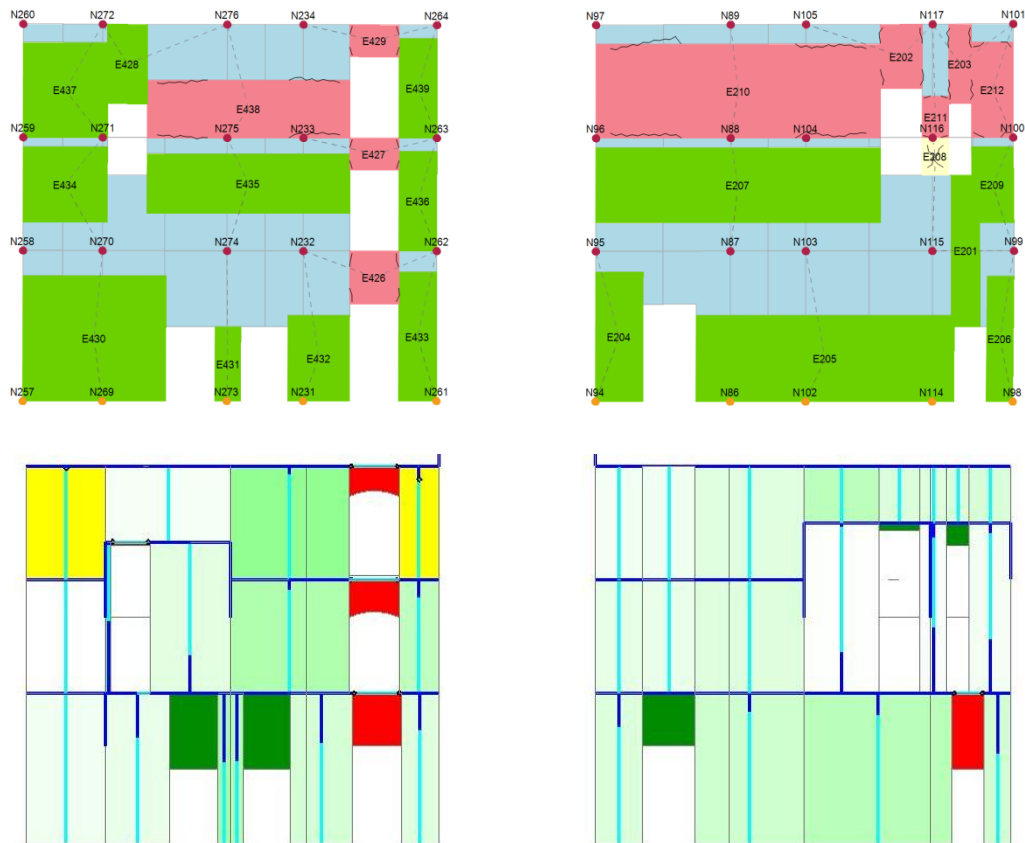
Parete 32 e 10: pareti interne in direzione Y
